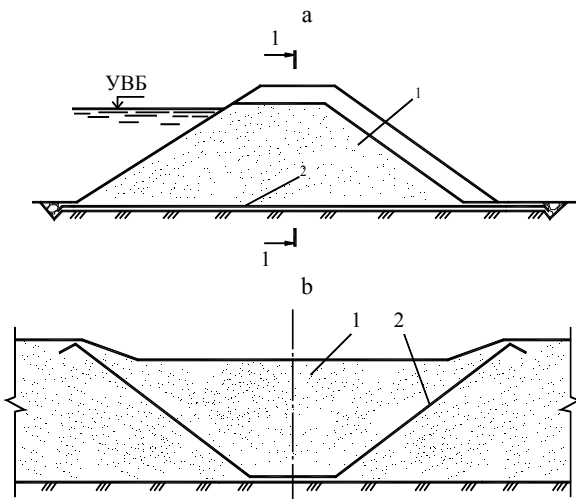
Водосброс с размываемой грунтовой вставкой с ограничивающей размыв одеждой из мягкого полимерного материала: а – поперечный разрез; б – продольный разрез 1–1; 1 – размываемая вставка; 2 – геотекстиль или полимерная пленка; УВБ – уровень верхнего бьефа
